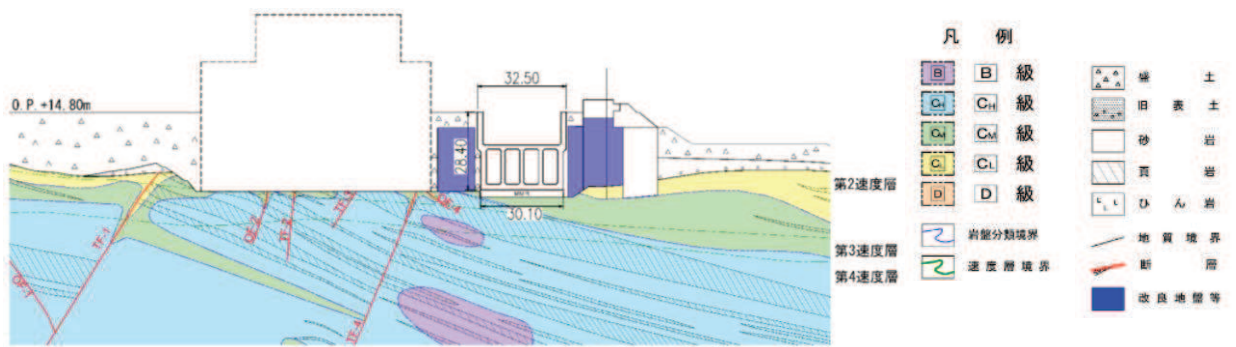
地盤改良体の配置図（海水ポンプ室横断，C-C 断面）
